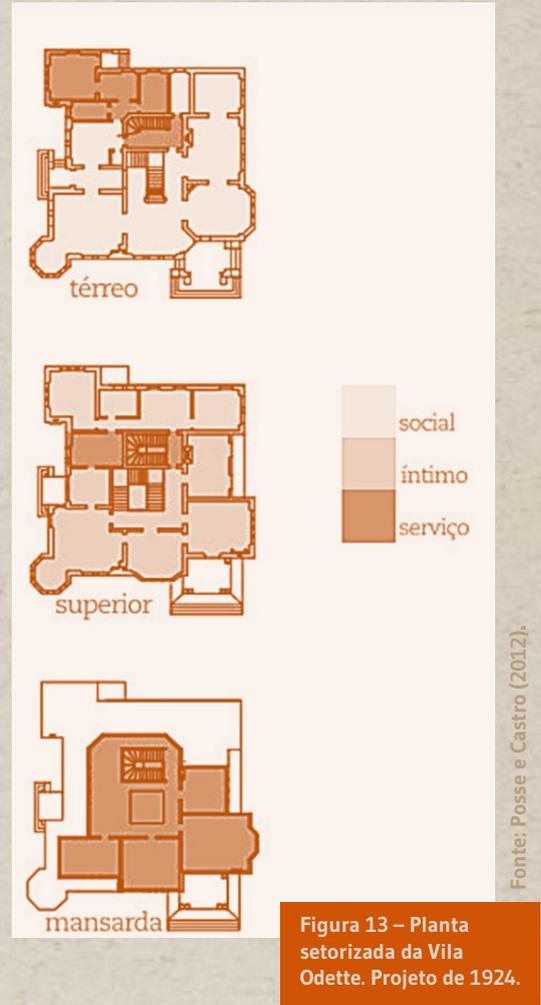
Planta setorizada da Vila Odette. Projeto de 1924.
